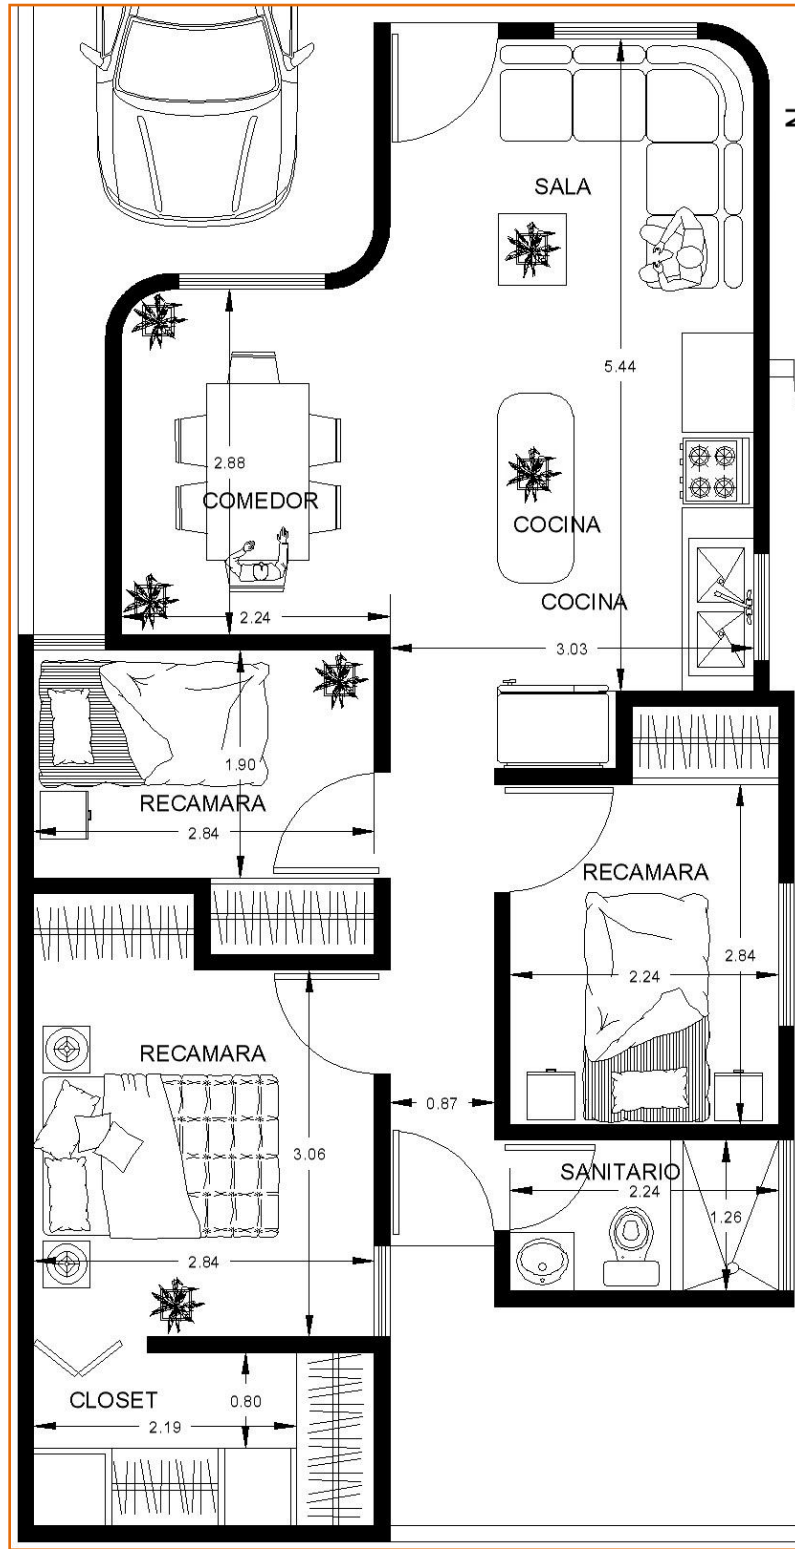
Plano de propuesta arquitectónica para caso de estudio 3.
